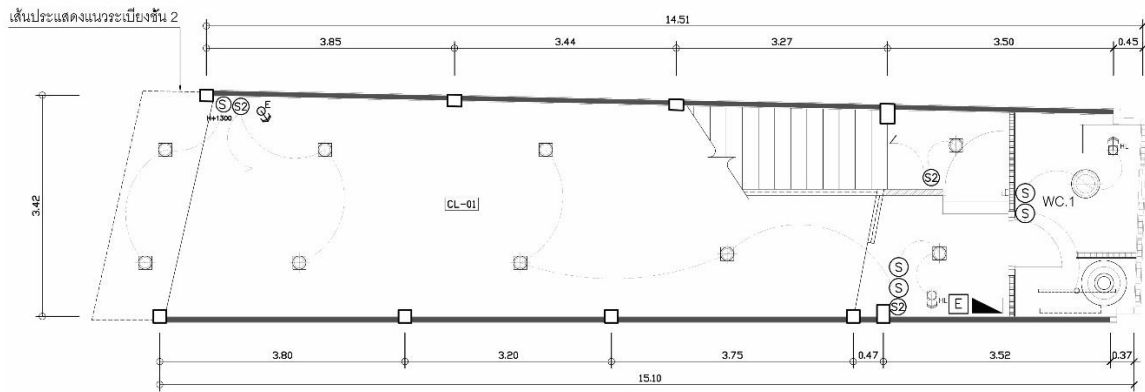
Furniture lay out plan & Zoning Floor 1st
